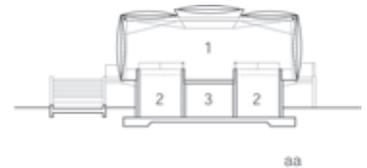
Grundrisse, Schnitte Pavillon im Earth Centre, Doncaster
